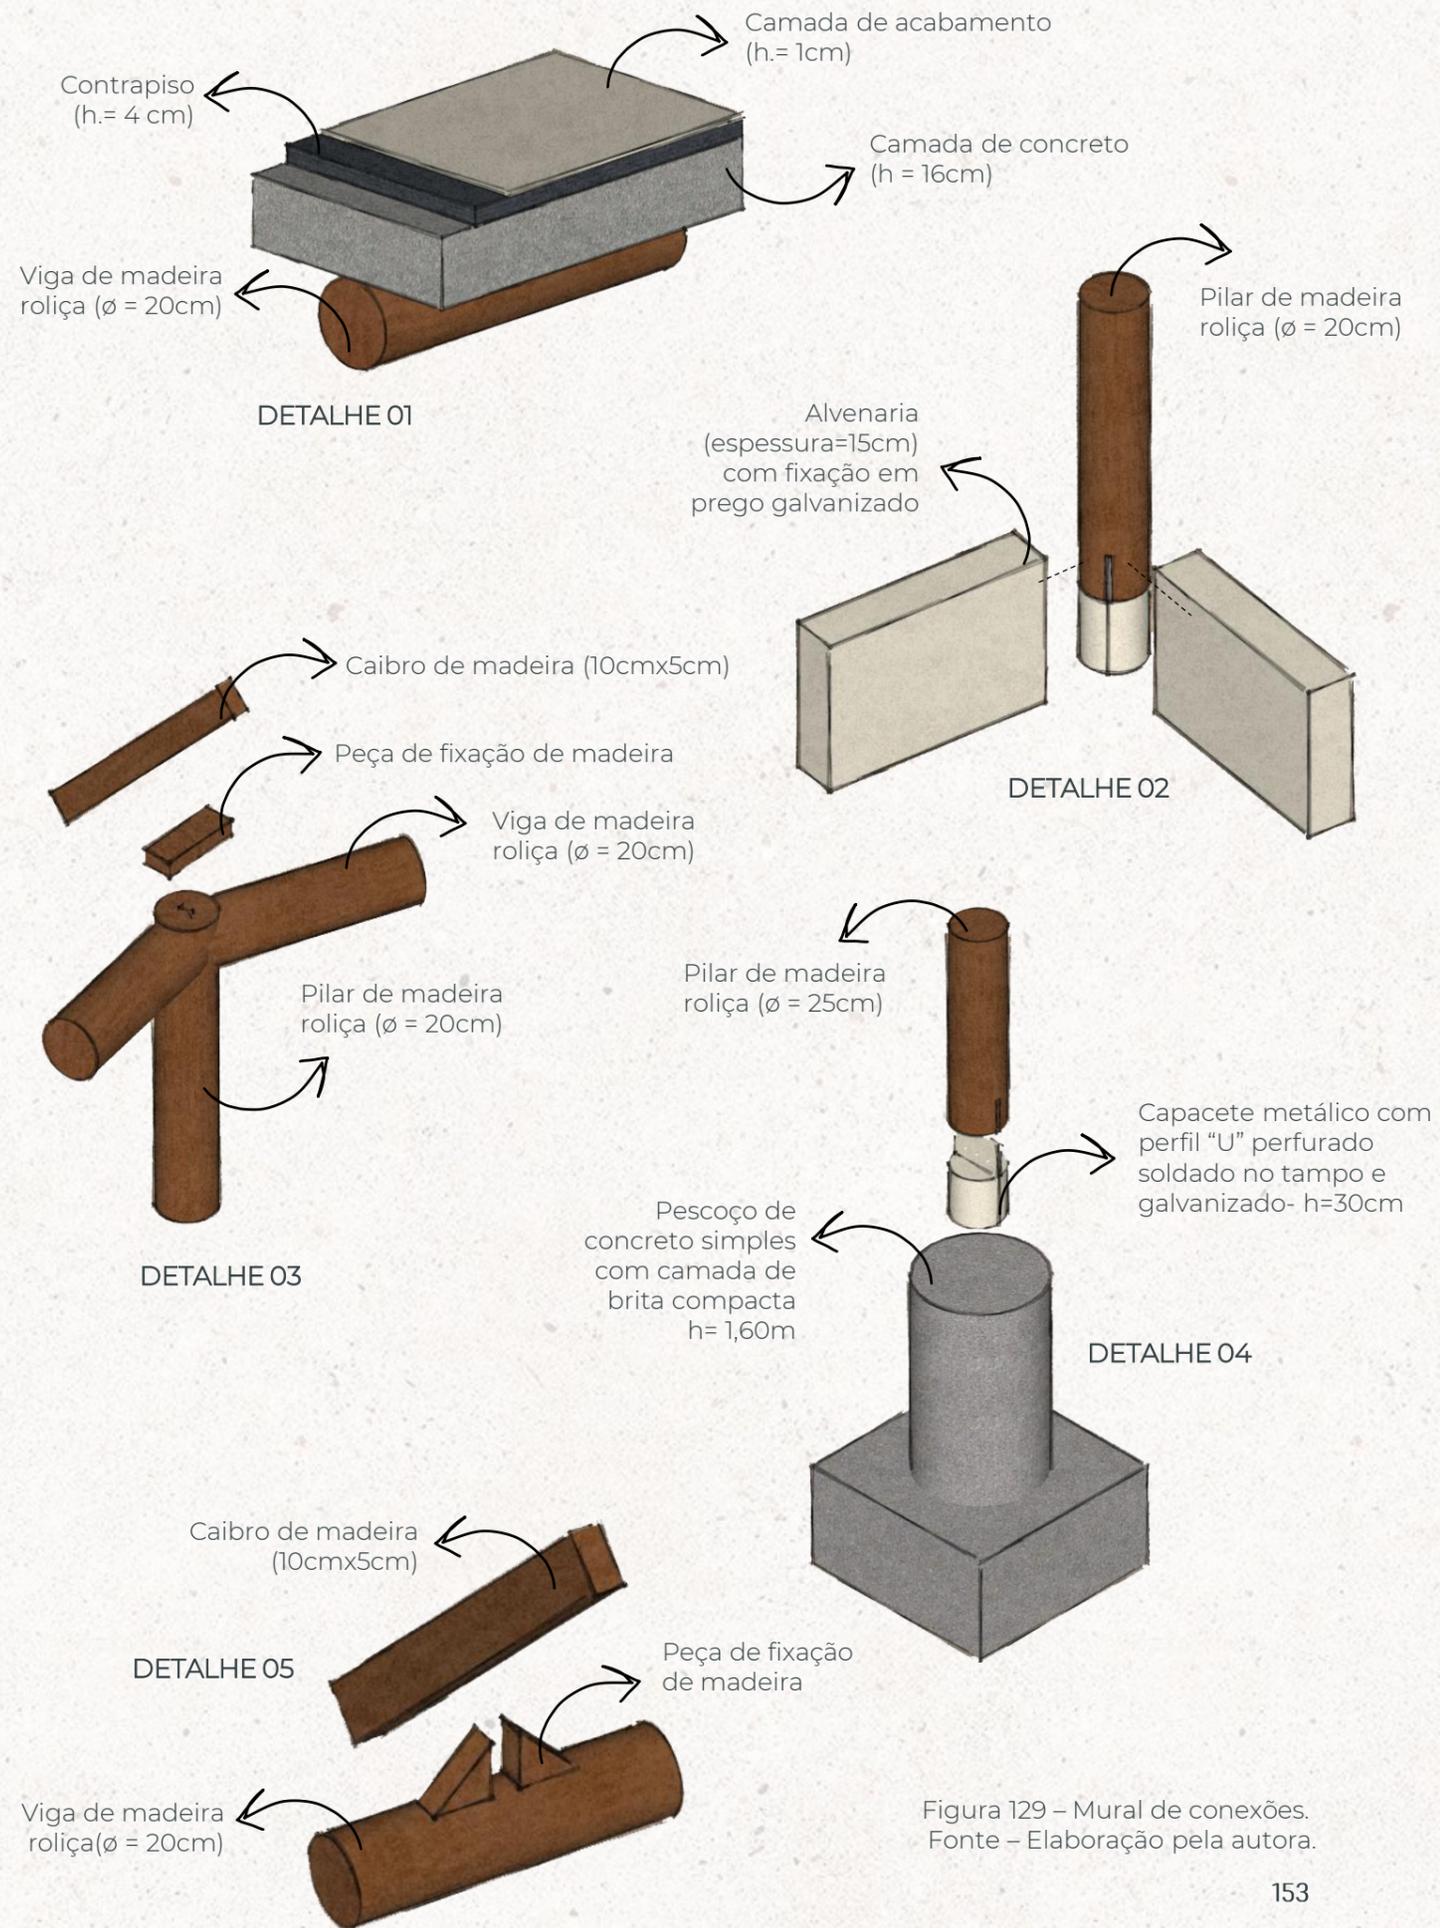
Mural de conexões. Fonte – Elaboração pela autora.
